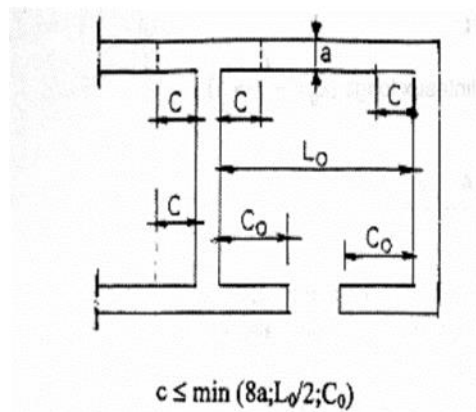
vue en plan d'un noyau et les conditions de rigidités aux extrémités
